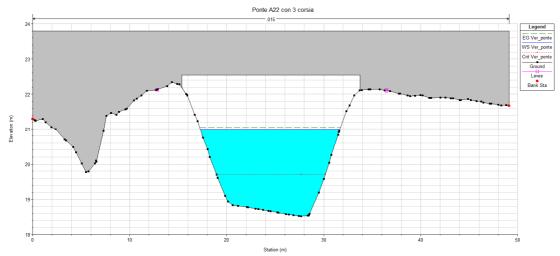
Sezione trasversale del ponte dell'Autostrada del Brennero sul Canale Acque Alte - stato di progetto
